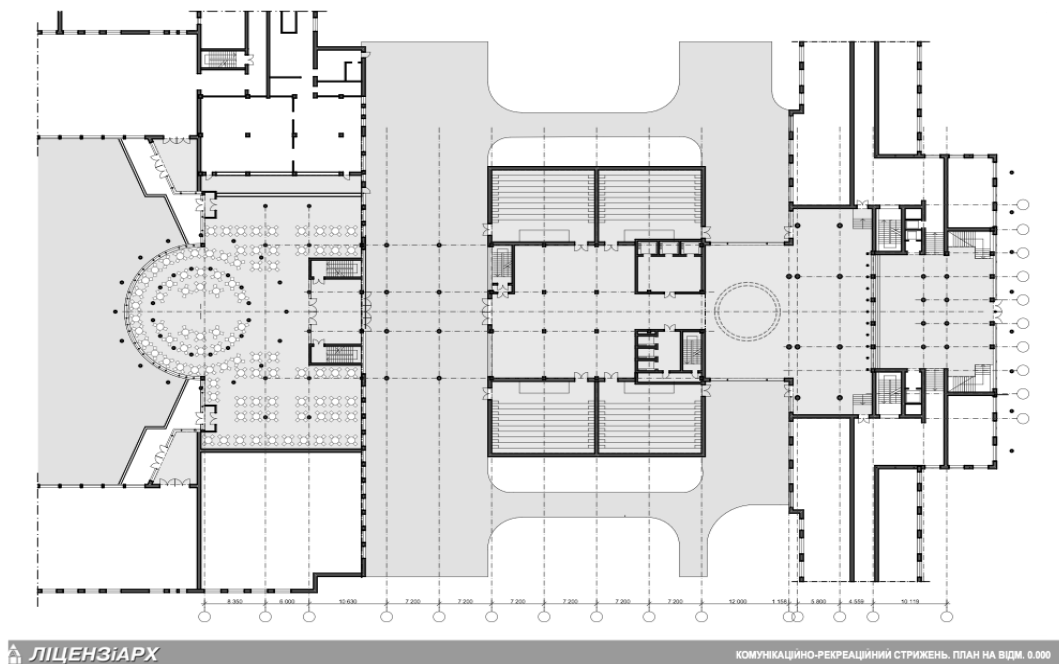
Комунікаційний планувально-просторовий стрижень. План першого поверху. Пропозиція
